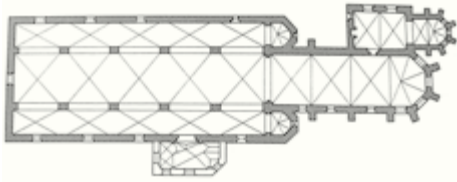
Grundriss der Dominikanerkirche in Friesach
